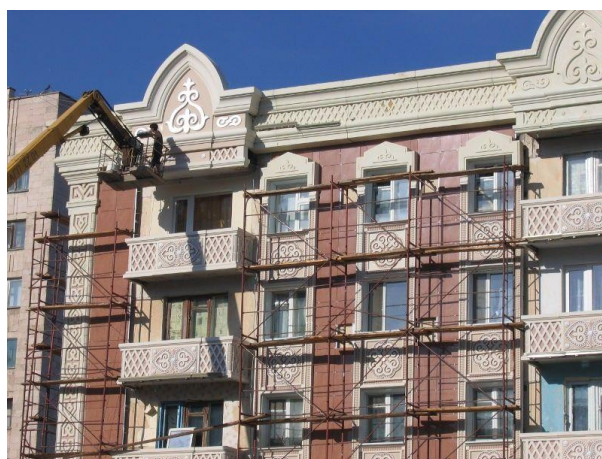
Реконструкция (капитальный ремонт) фасада
